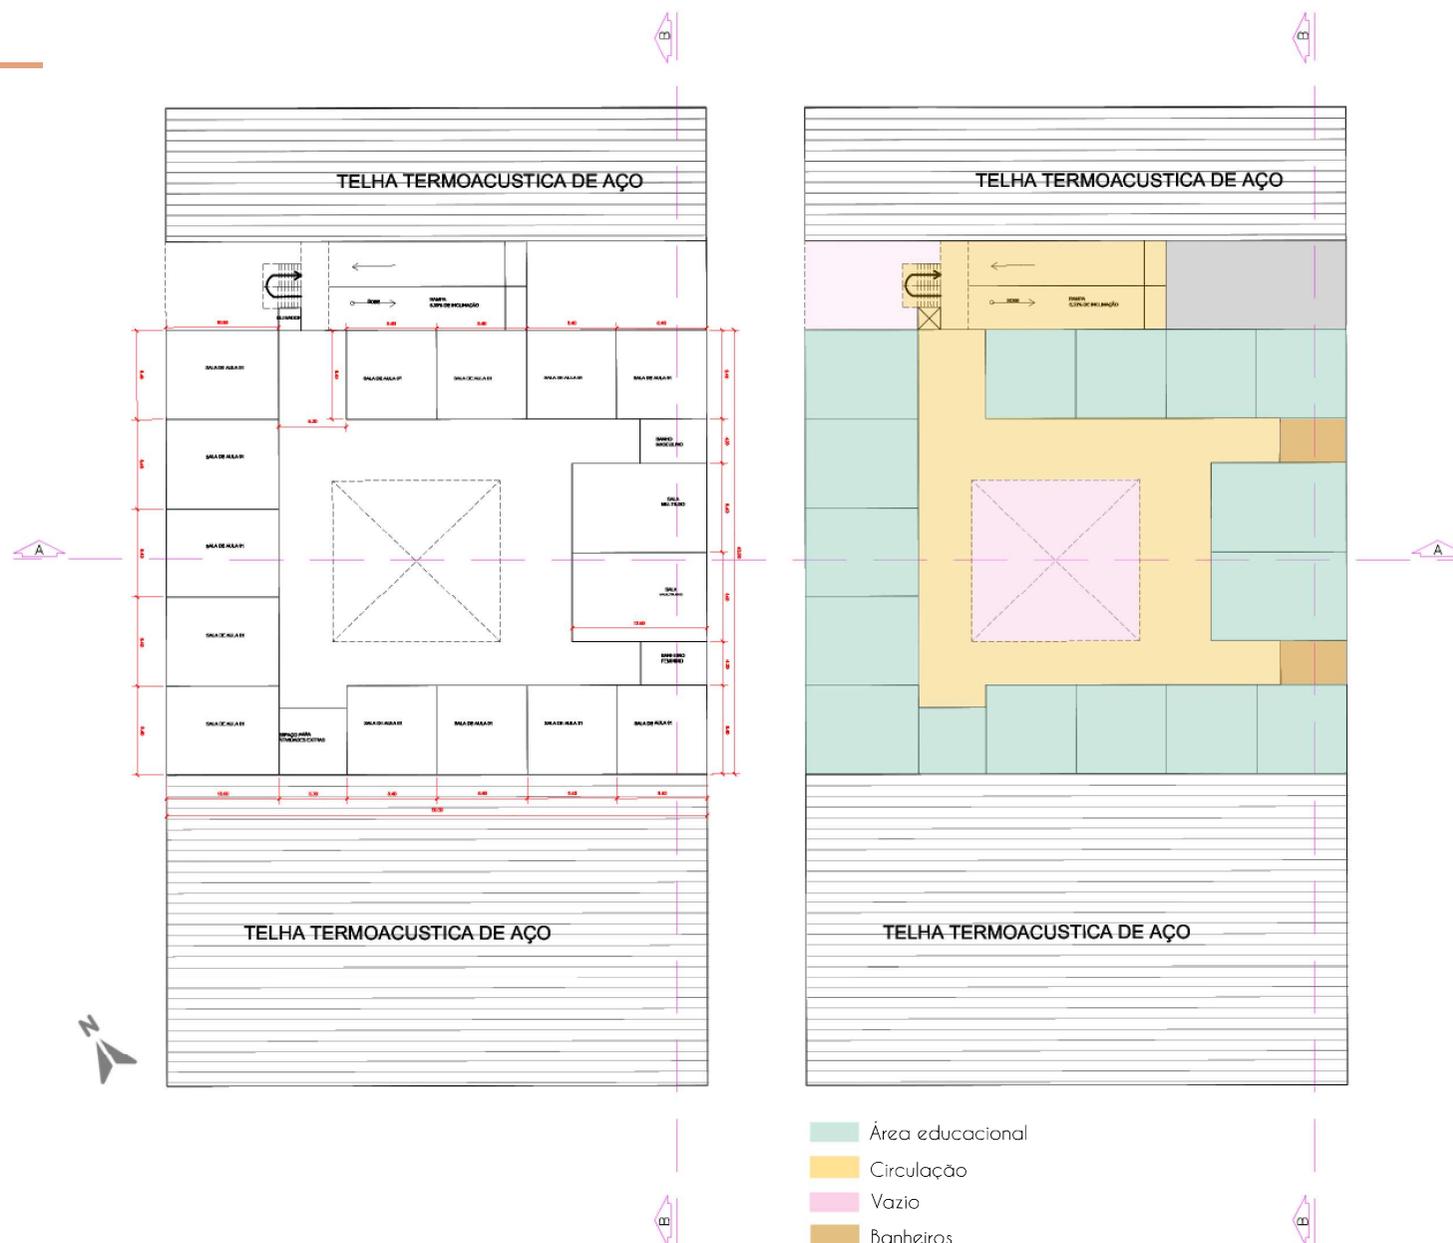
Planta do 2 pavimento- Fonte: Desenvolvido pela autora
